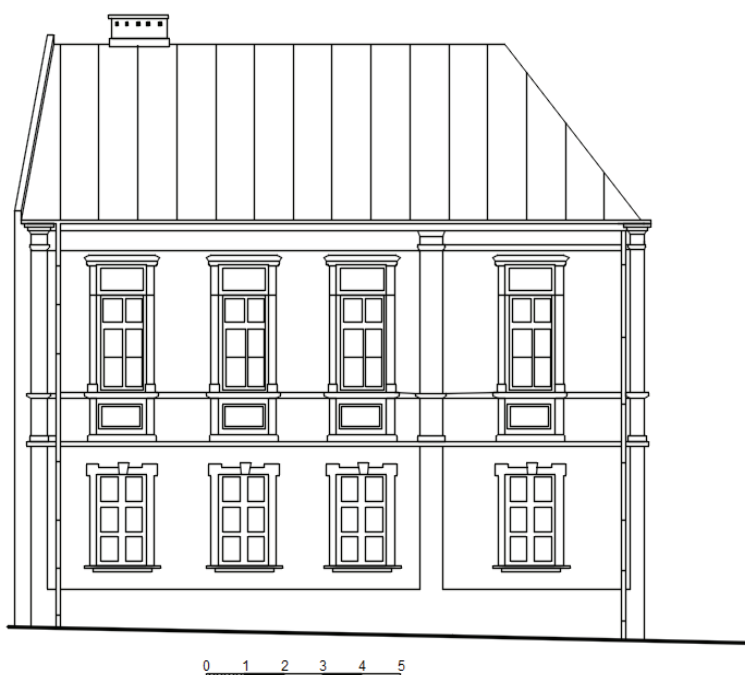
Elewacja zachodnia (należy podać kierunek elewacji)
